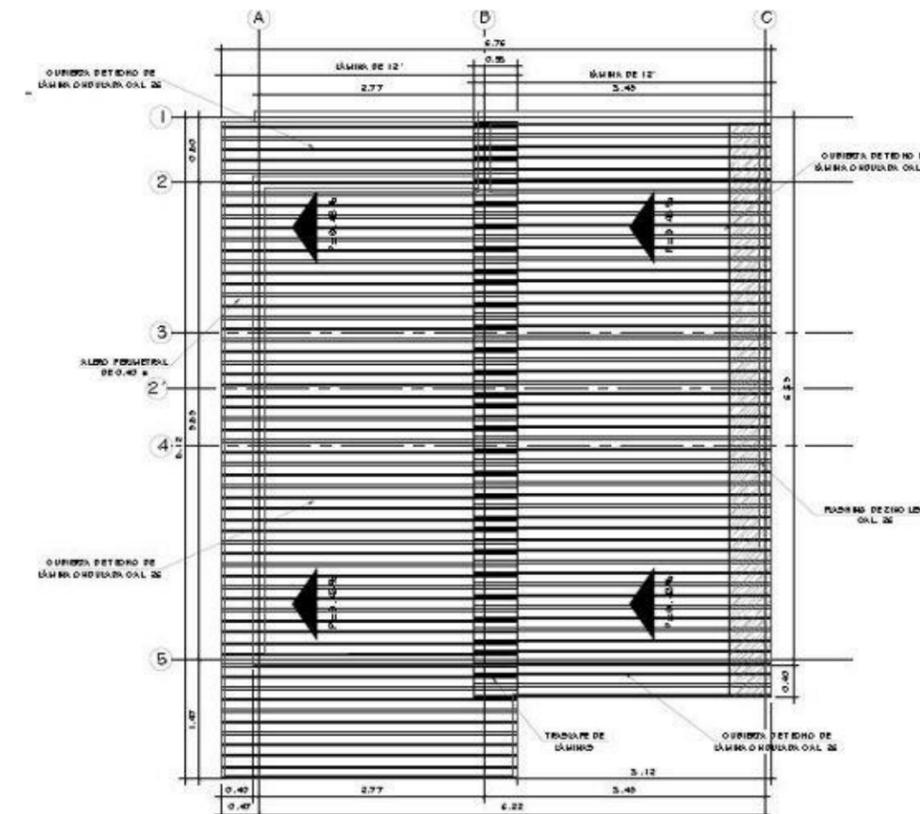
Plano de Techo Fuente: Asociación Roncalli
